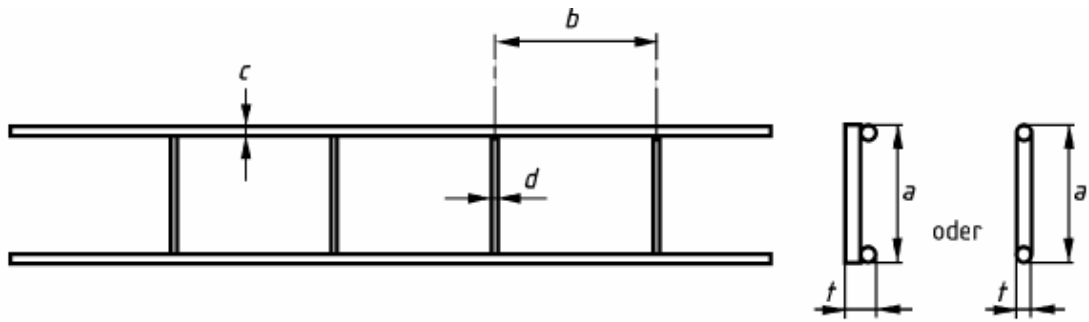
Пример арматуры решетчатого типа – вид сверху и вид в разрезе
